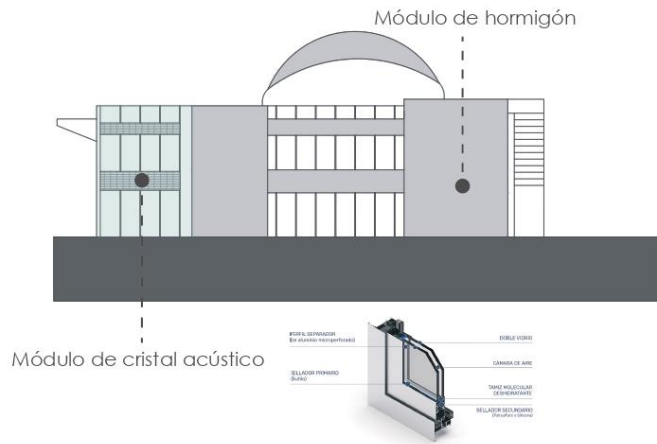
Modulación de Fachadas del Terminal Terrestre de Cumandá
